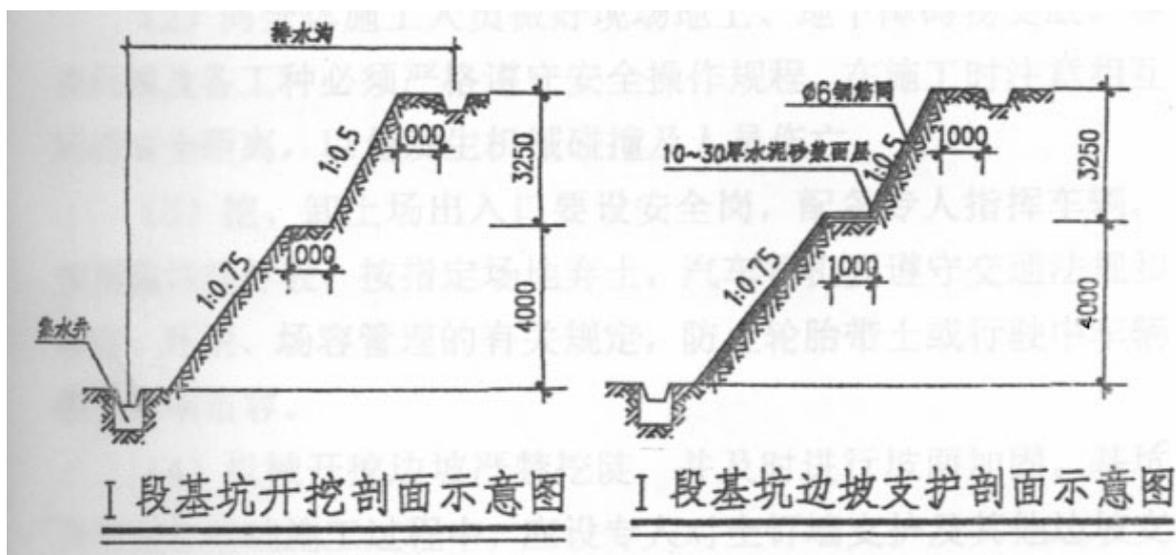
□段基坑开挖及基坑边坡支护剖面示意图
